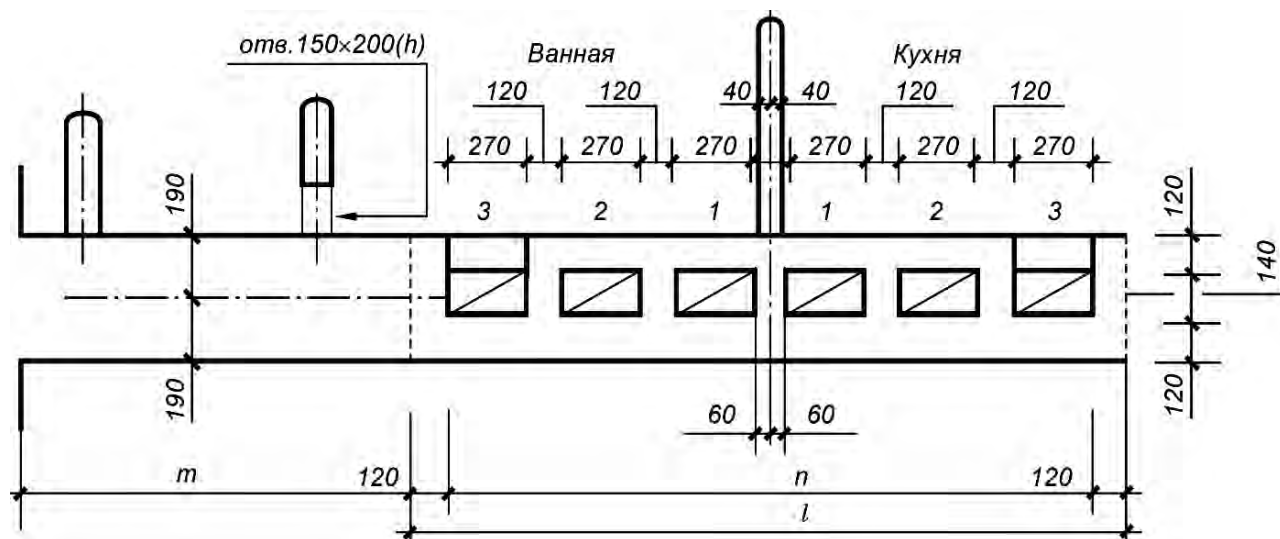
Пример расположения вентиляционных каналов в кирпичной стене на уровне 3-го этажа
